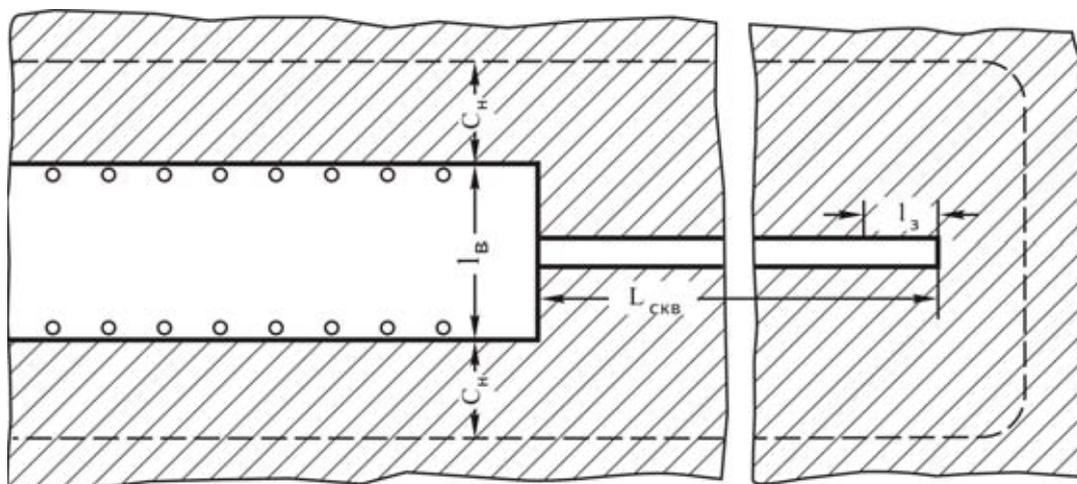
Расчетная схема для определения объема угольного массива, подвергаемого увлажнению при проведении подготовительных выработок.
